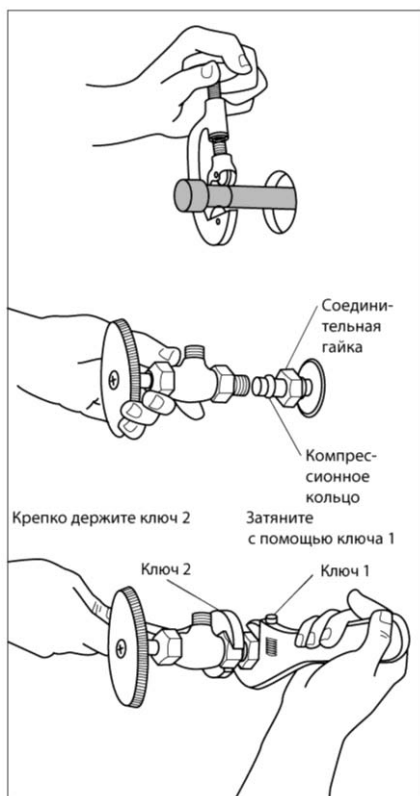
Для монтажа дополнительного перекрывающего воду вентиля на медную трубу разрежьте старую трубу. Затем используйте компрессионный фитинг, как показано на рисунке
